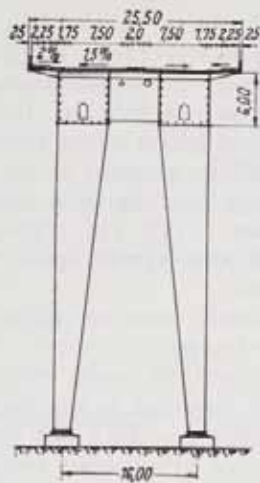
Projet 3.4. Coupe avec vue des béquilles
